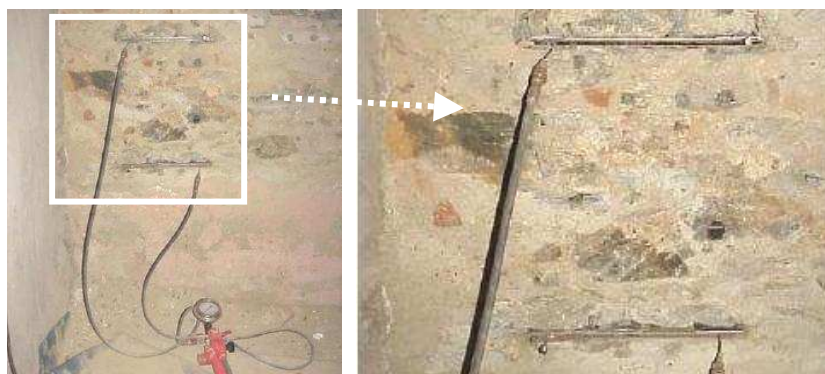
Ensaio com macacos planos duplos [47]
